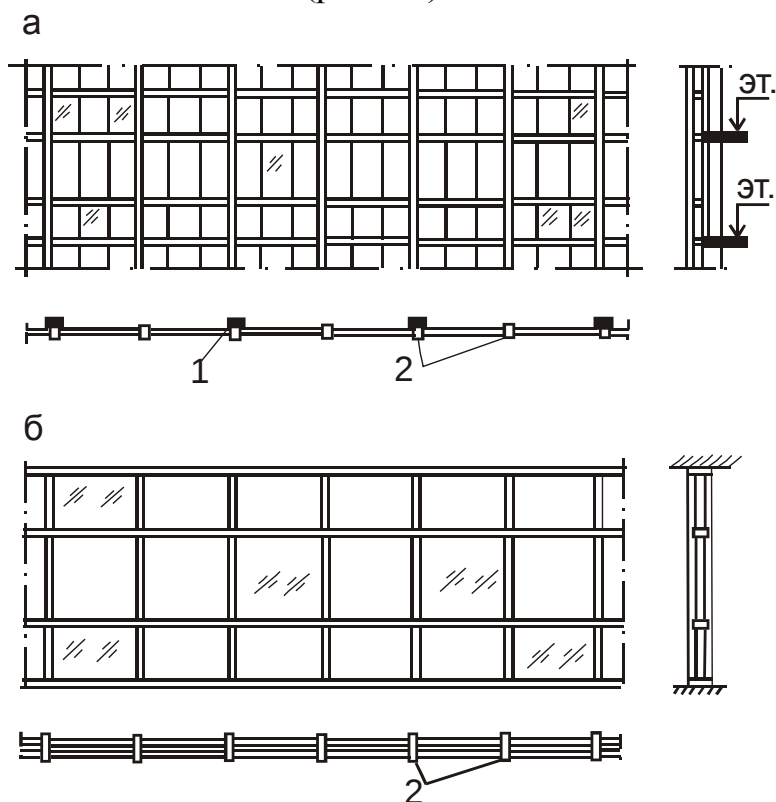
Схема витражей: а – с поэтажным креплением к перекрытиям; б – с креплением к покрытию и цоколю; 1 – каркас; 2 – импосты
